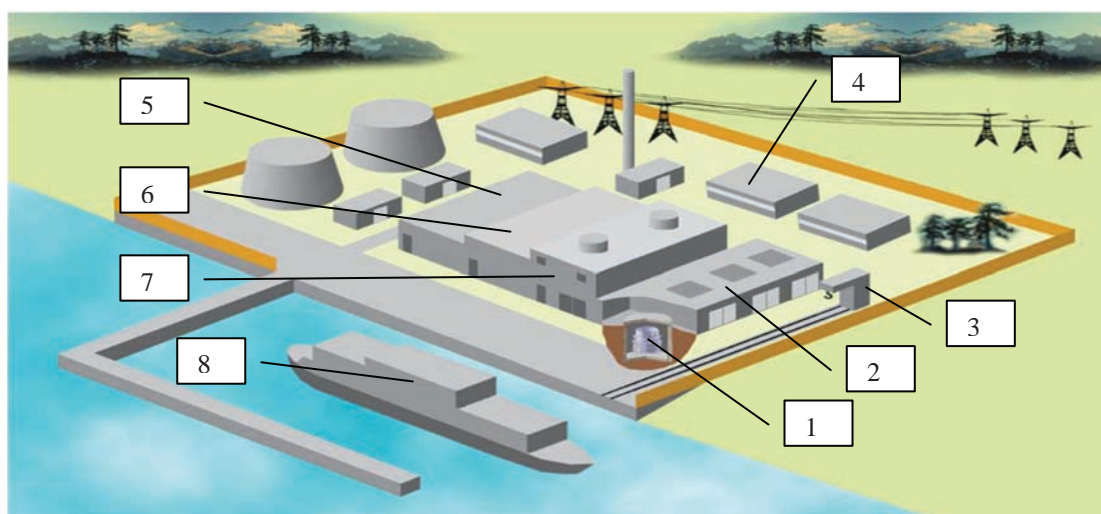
Примерный план размещения БАСММ мощностью 30 МВт (эл) с тремя ТРБ с РУ СВБР-10: 1 – ТРБ, 2 – здание для установки ТРБ, 3 – грузоподъемное устройство, 4 – пульт управления, 5 – здание общестанционных дизель-генераторов, 6 – здание электроснабжения нормальной эксплуатации, 7 – машинное отделение, 8 – транспортное судно
